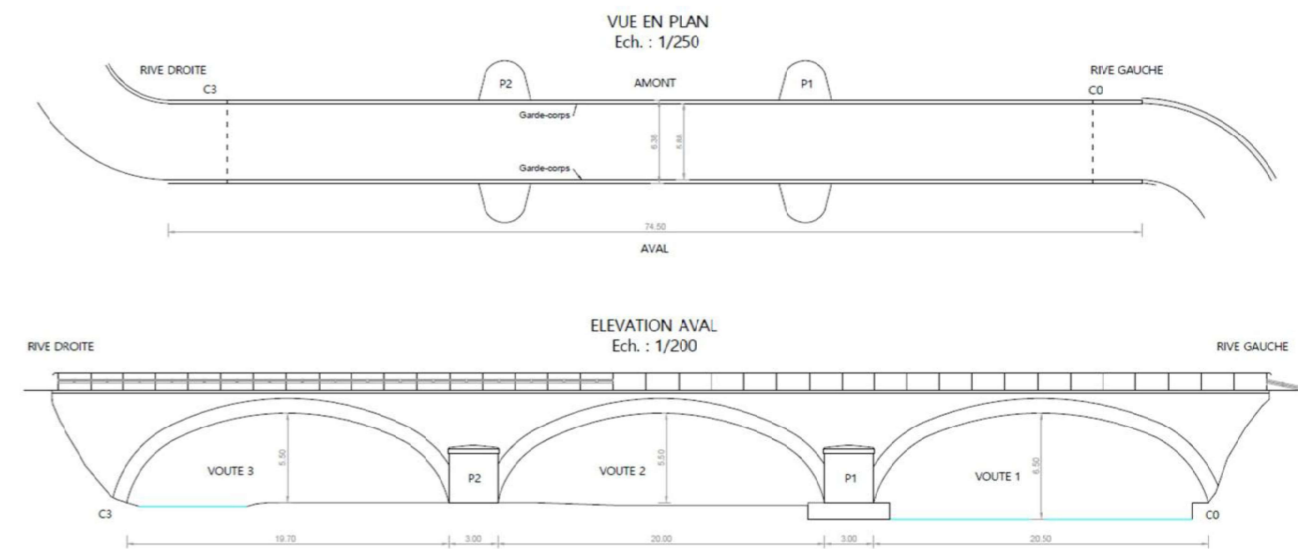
Extraits des vues en plan et en élévation du pont existant
